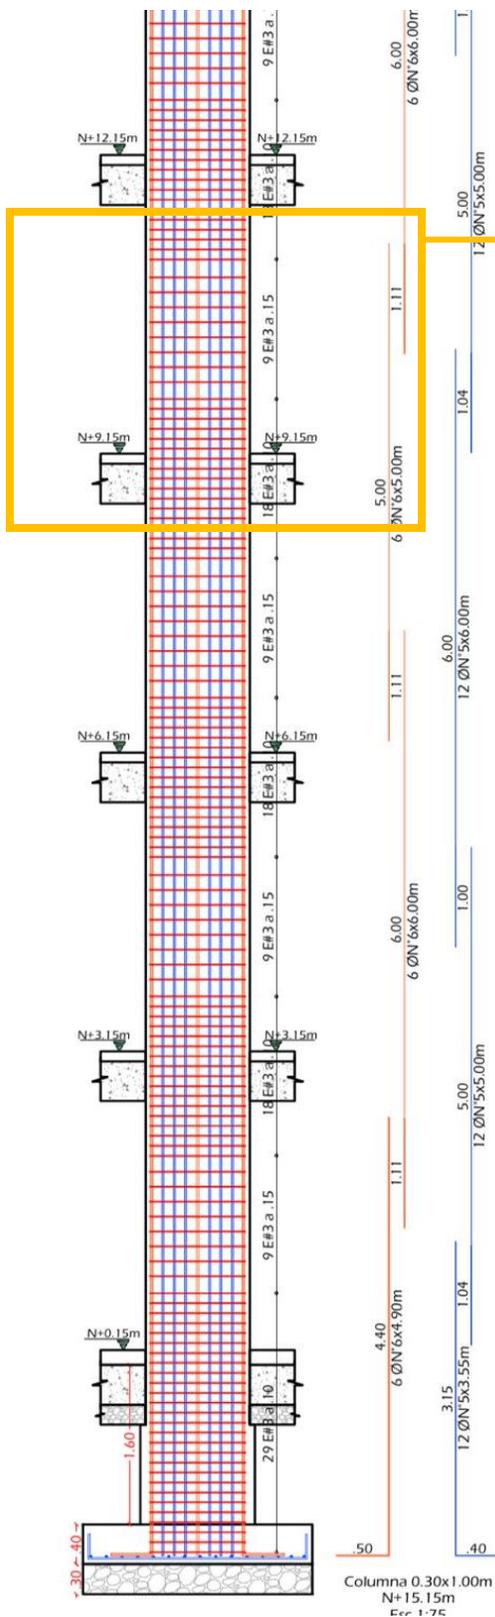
Despiece transversal y longitudinal de columna T3 plano Wiedii
